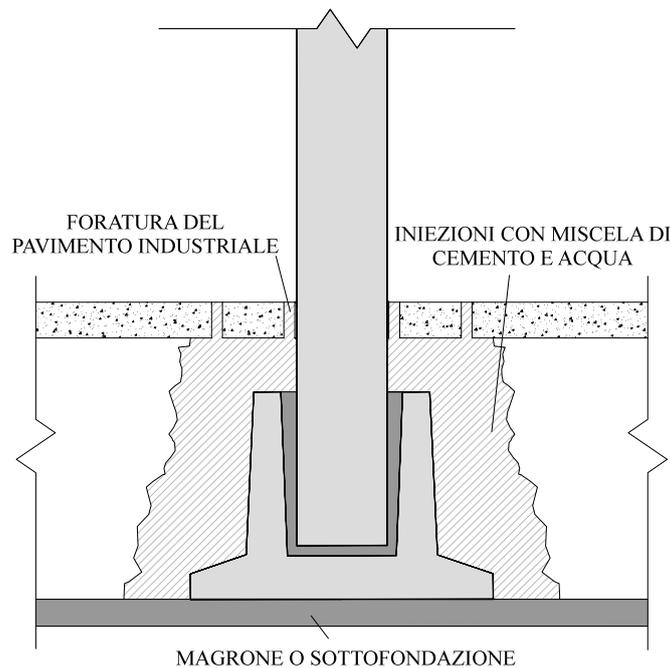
Consolidamento del terreno circostante la fondazione mediante iniezioni con miscele cementizie a bassa pressione
